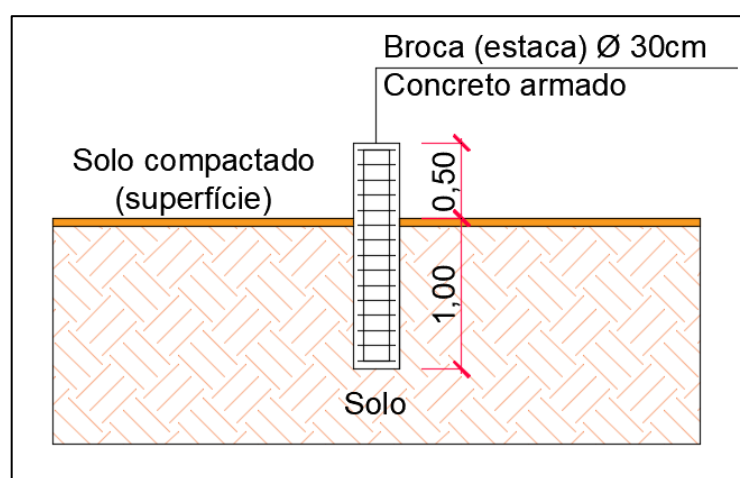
Imagem 12– Detalhamento da fundação das estruturas dos painéis.
